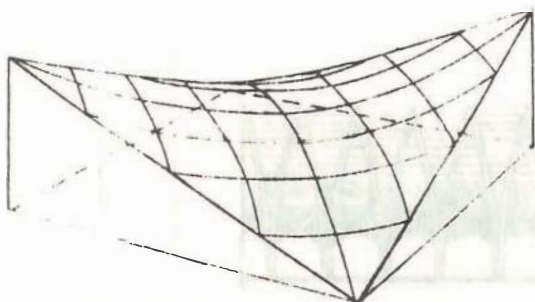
Distintos tipos de elementos estructurales en madera laminada.
